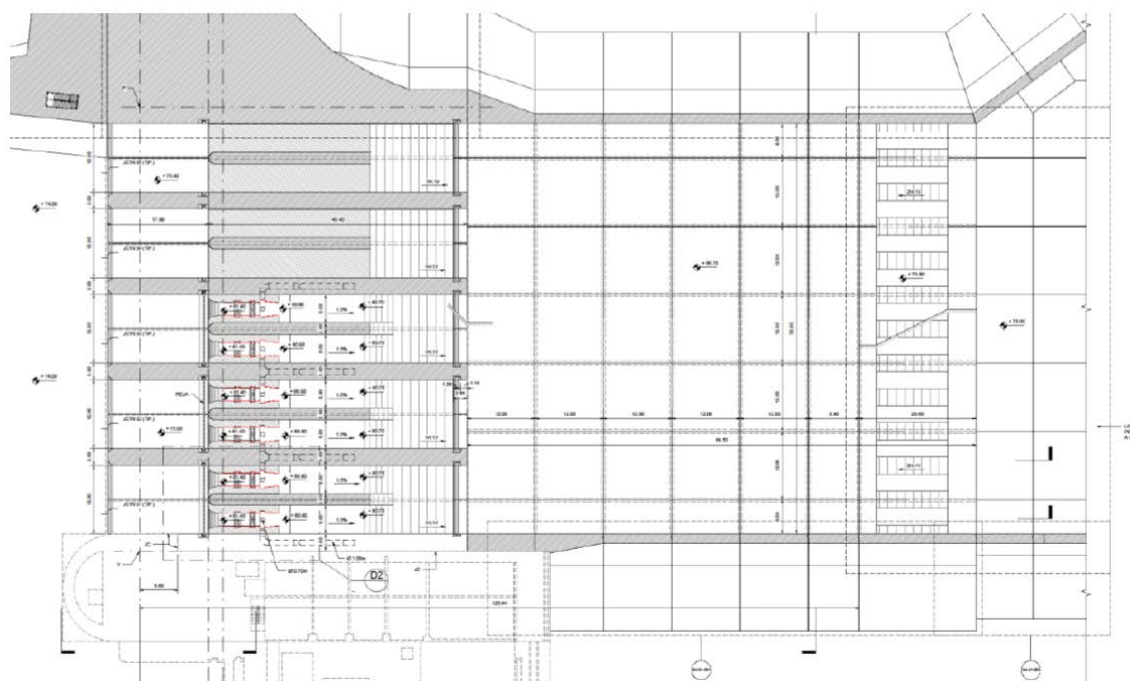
JC - Descargador de fondo – Planta (Fuente: Elaboración propia)
